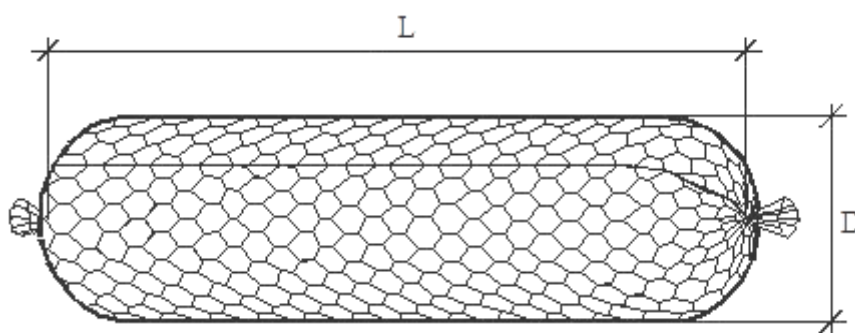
Конструктивная схема габионной конструкции цилиндрической формы
